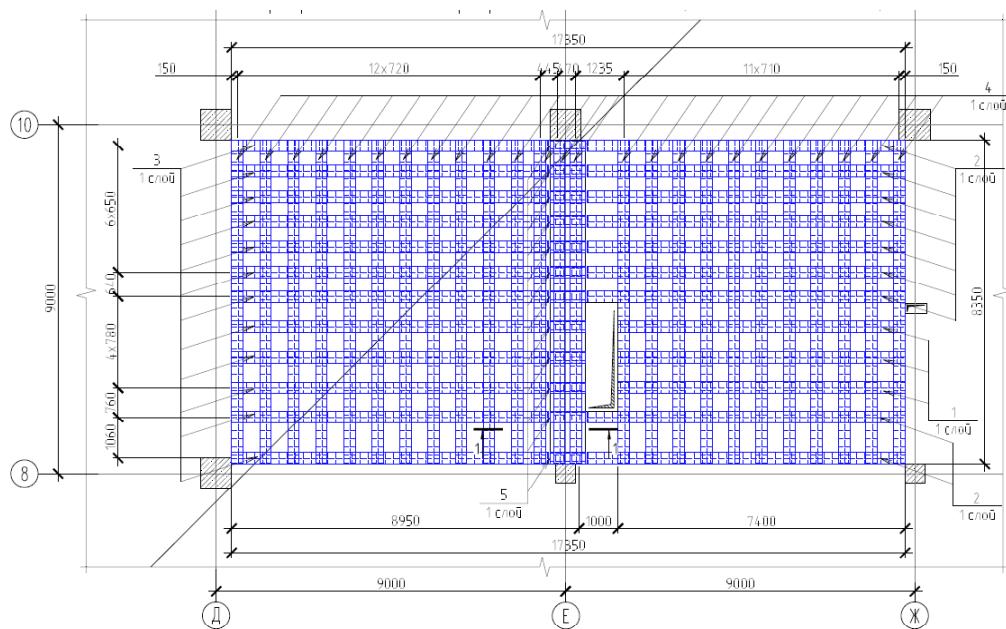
Нижнее армирование плиты перекрытия на отм.- 4.350 (наклейка на потолок)
